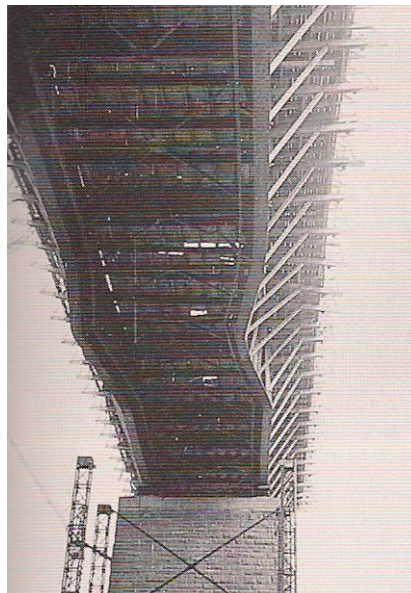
Ponte rodoviária Lauterbach com falha nas vigas inferiores
